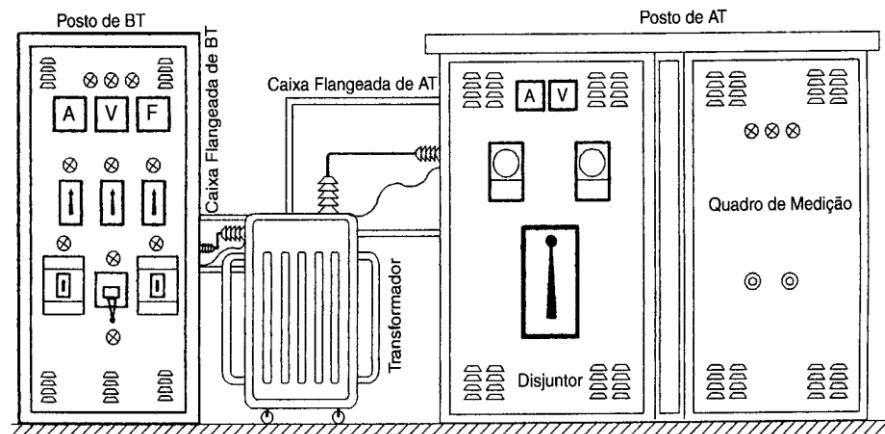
SE Modular Metálica (MAMEDE FILHO, 2010).
